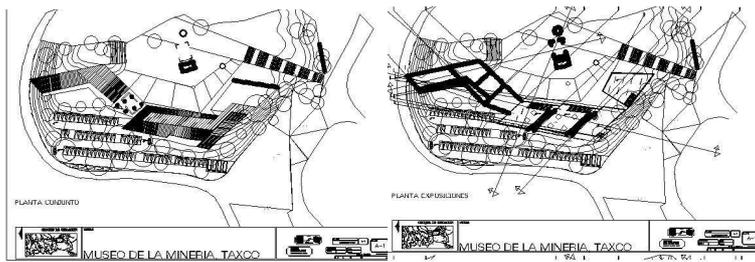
Esquemas de Plantas Arquitectónicas
